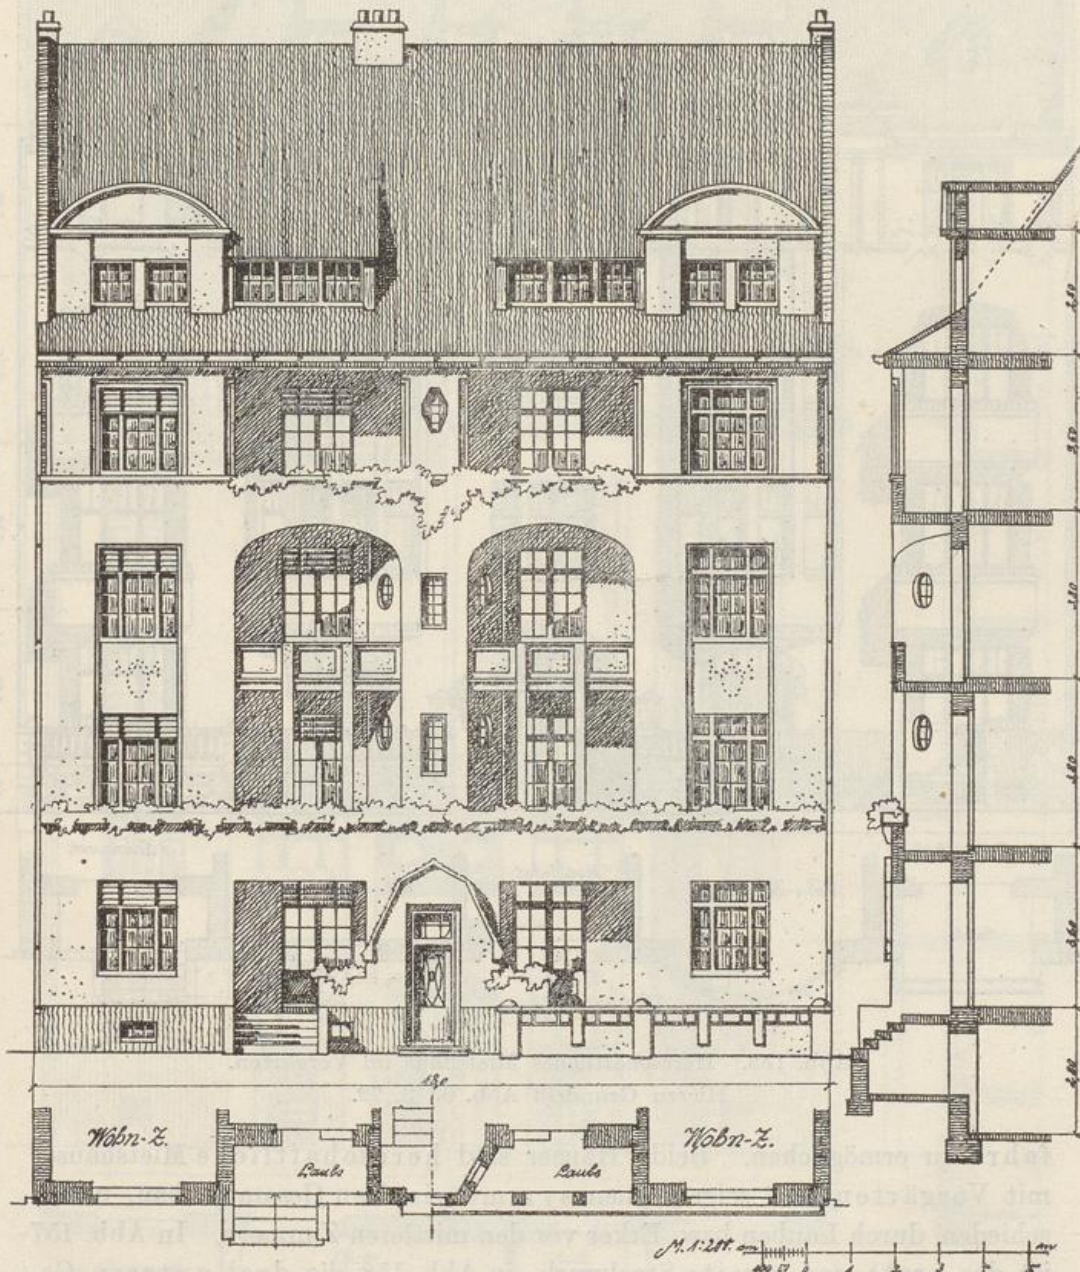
Herrschaftliches Mietshaus mit je zwei Wohnungen in vier Geschossen und Vorgarten. Vergl. Grundriß Abb. 93 S. 72.
